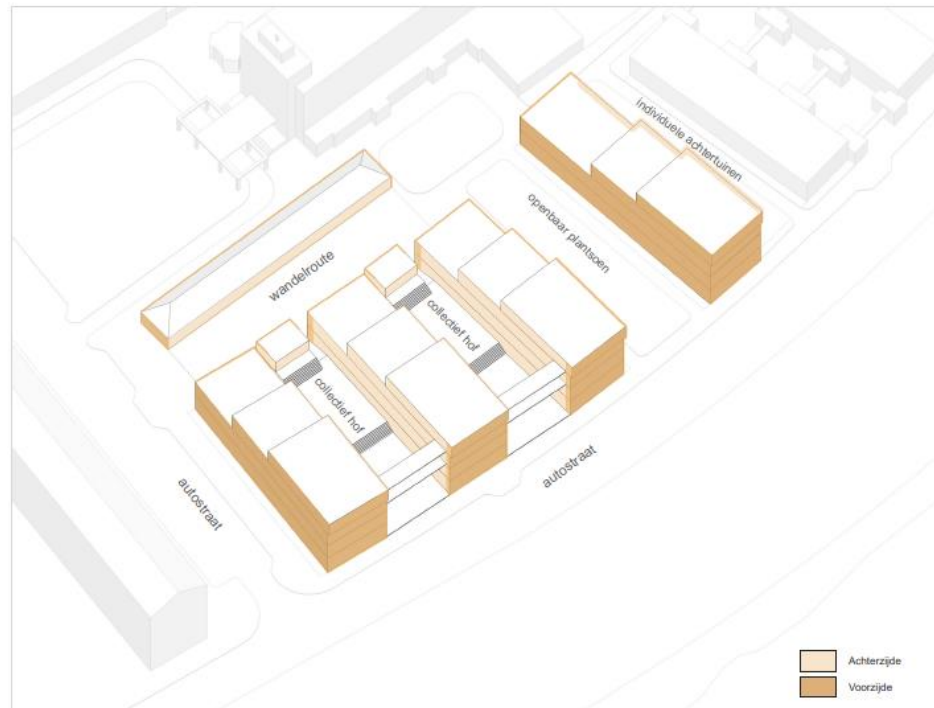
Zichtlijnen (bron: stedenbouwkundig plan Fridtjof Nansenhof, DOOR Architecten, 2016)
